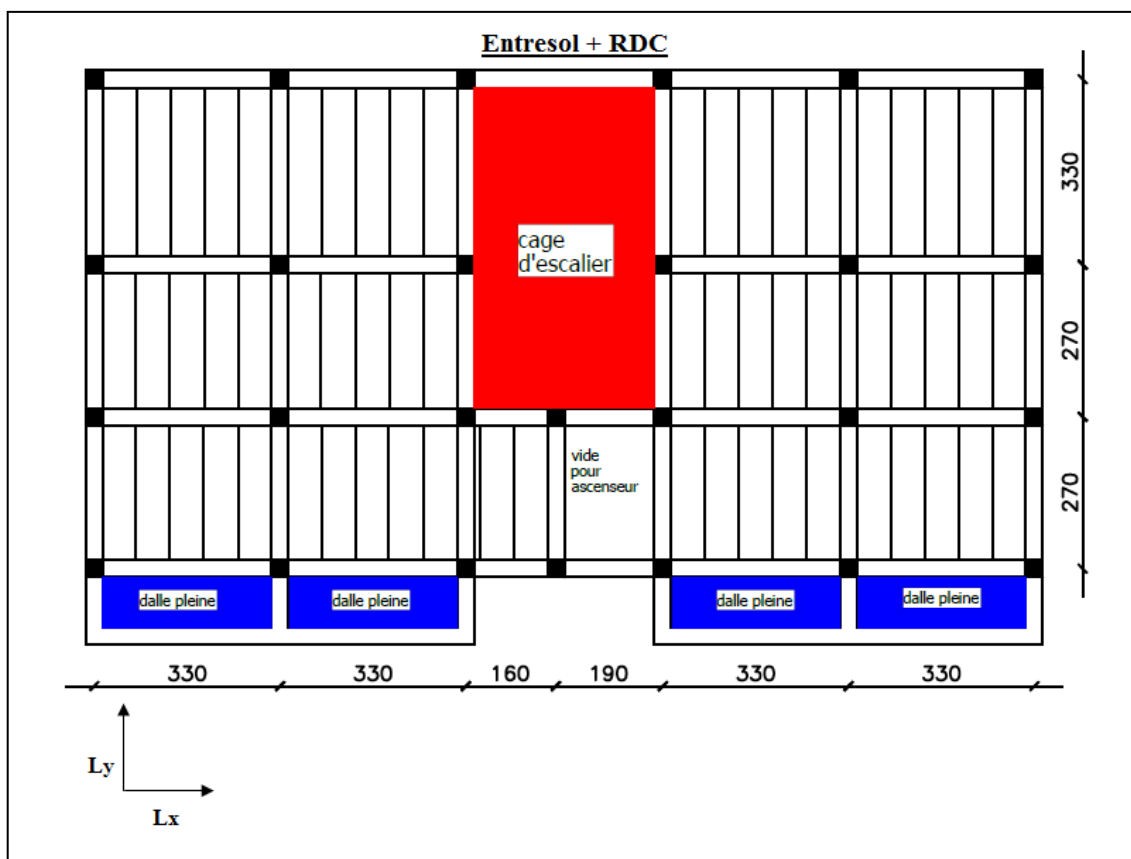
Plan de disposition des poutrelles (Entresol+RDC)
